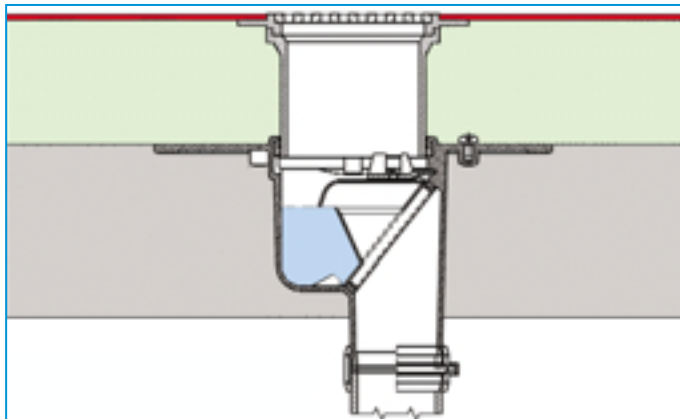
Bodenablauf zweiteilig mit Pressdichtungsflansch, Typ 4 in Bodenaufbau mit zwei Dichtungsbahnen
